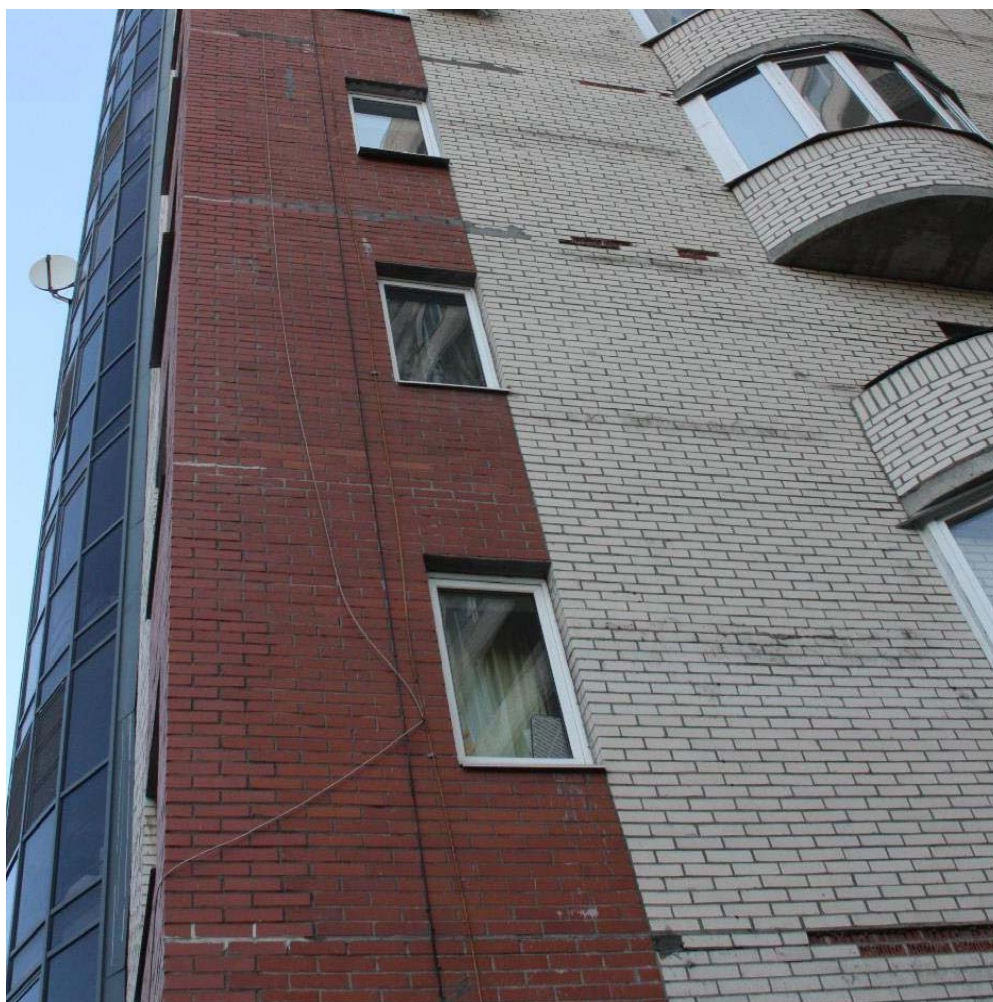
Руйнування кладки на рівні плит перекриття й тріщина в кутовій зоні
